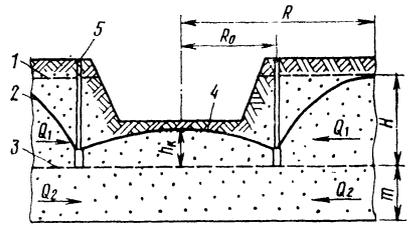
Расчетная схема грунтового водоотлива установками несовершенного типа:
